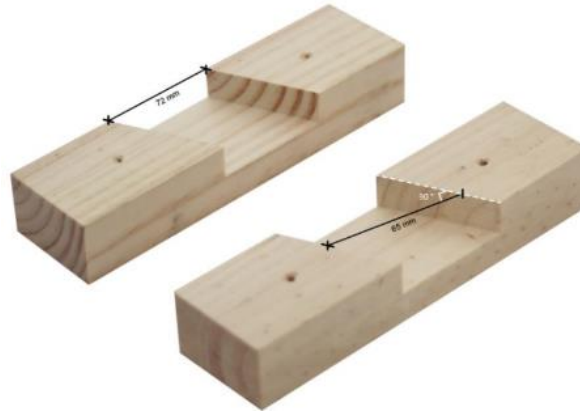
Ensamble caja y espiga unilateral | Detalle espiga 5 | Detalle ensamblaje.
